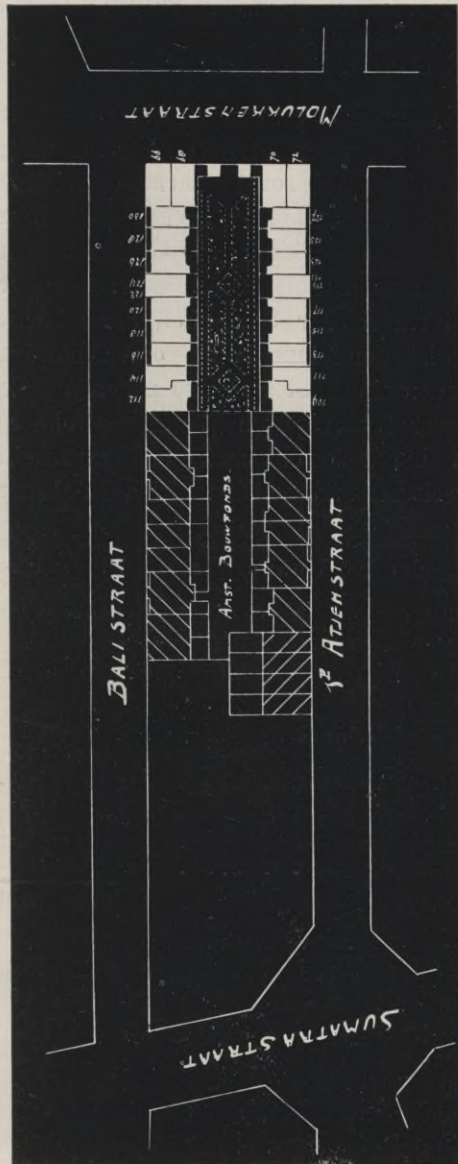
Baublock mit Innengärten. Erbauer Baugenossenschaft.
